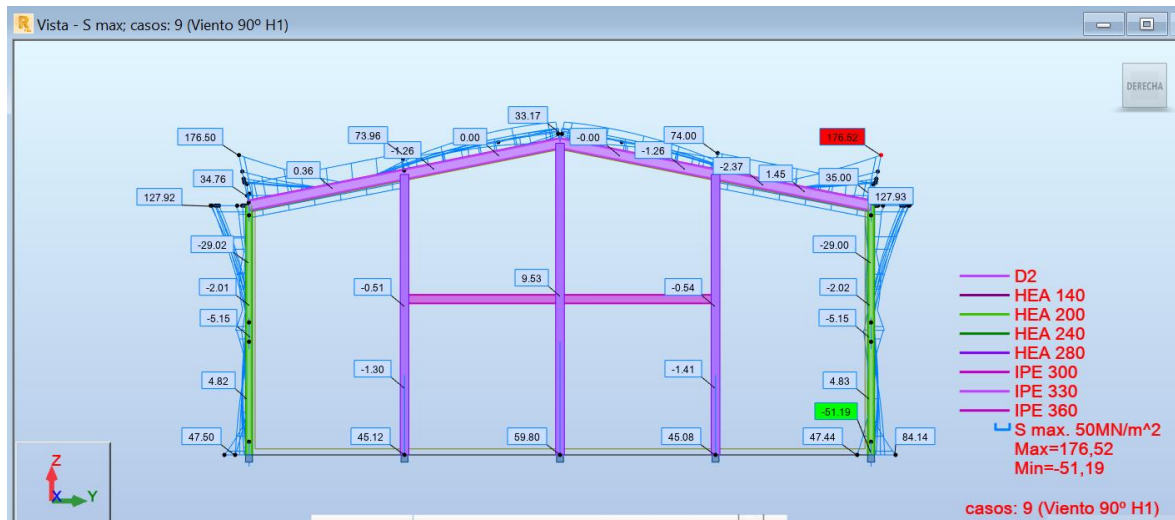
Tensiones vista alzado viento CTE 90° H1
